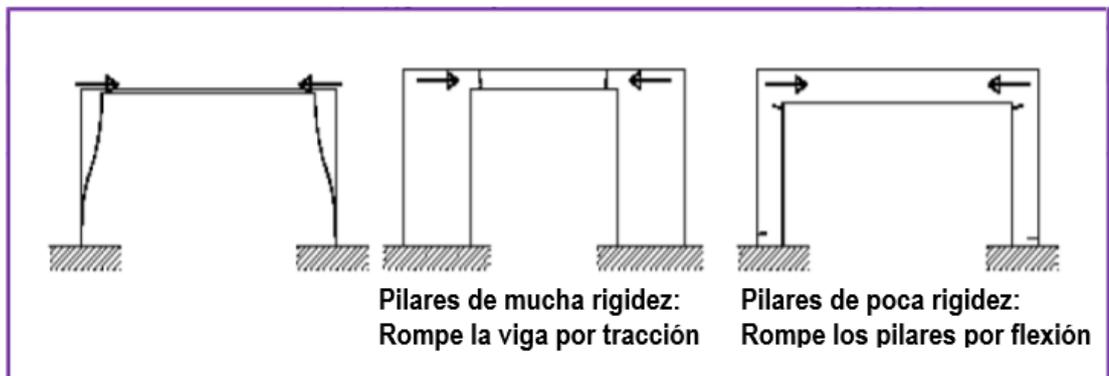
FISURAS POR RETRACCIÓN VIGAS Y COLUMNAS
